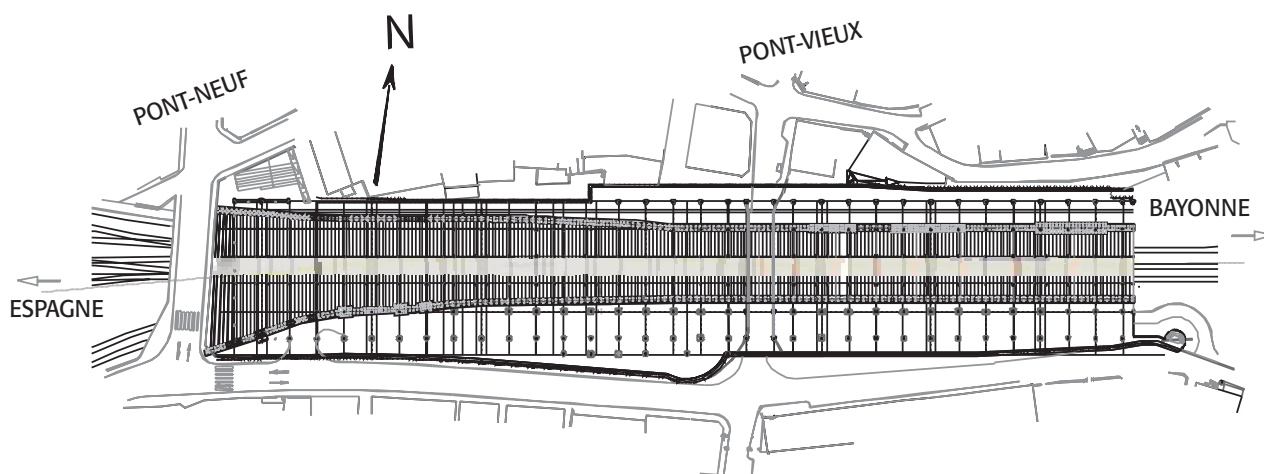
Vista en planta: desde el Pont Neuf (oeste) al Pont Vieux (centro) y más allá
